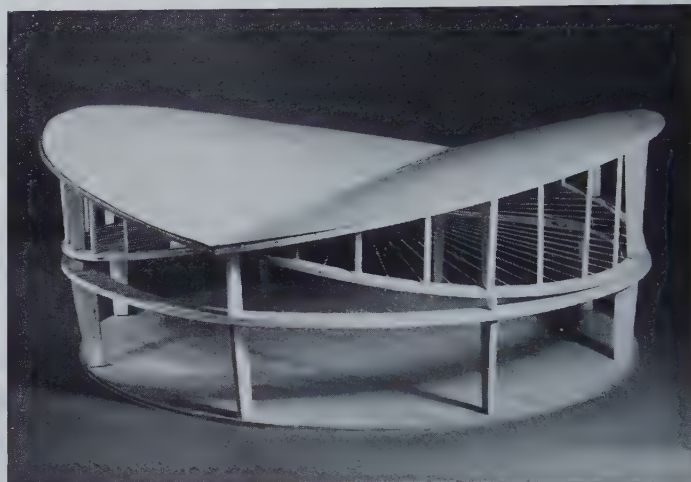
Modellbild einer aus zwei gegenseitig geneigten Spannwerken bestehenden Rundbauüberdachung mit Dachhaut
